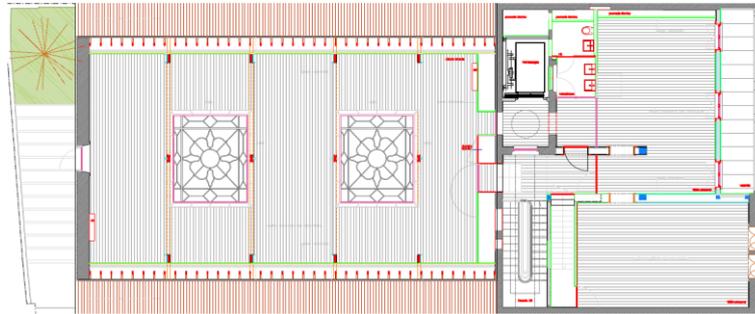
Planta do Piso 3 (Cota 112,25 m)
